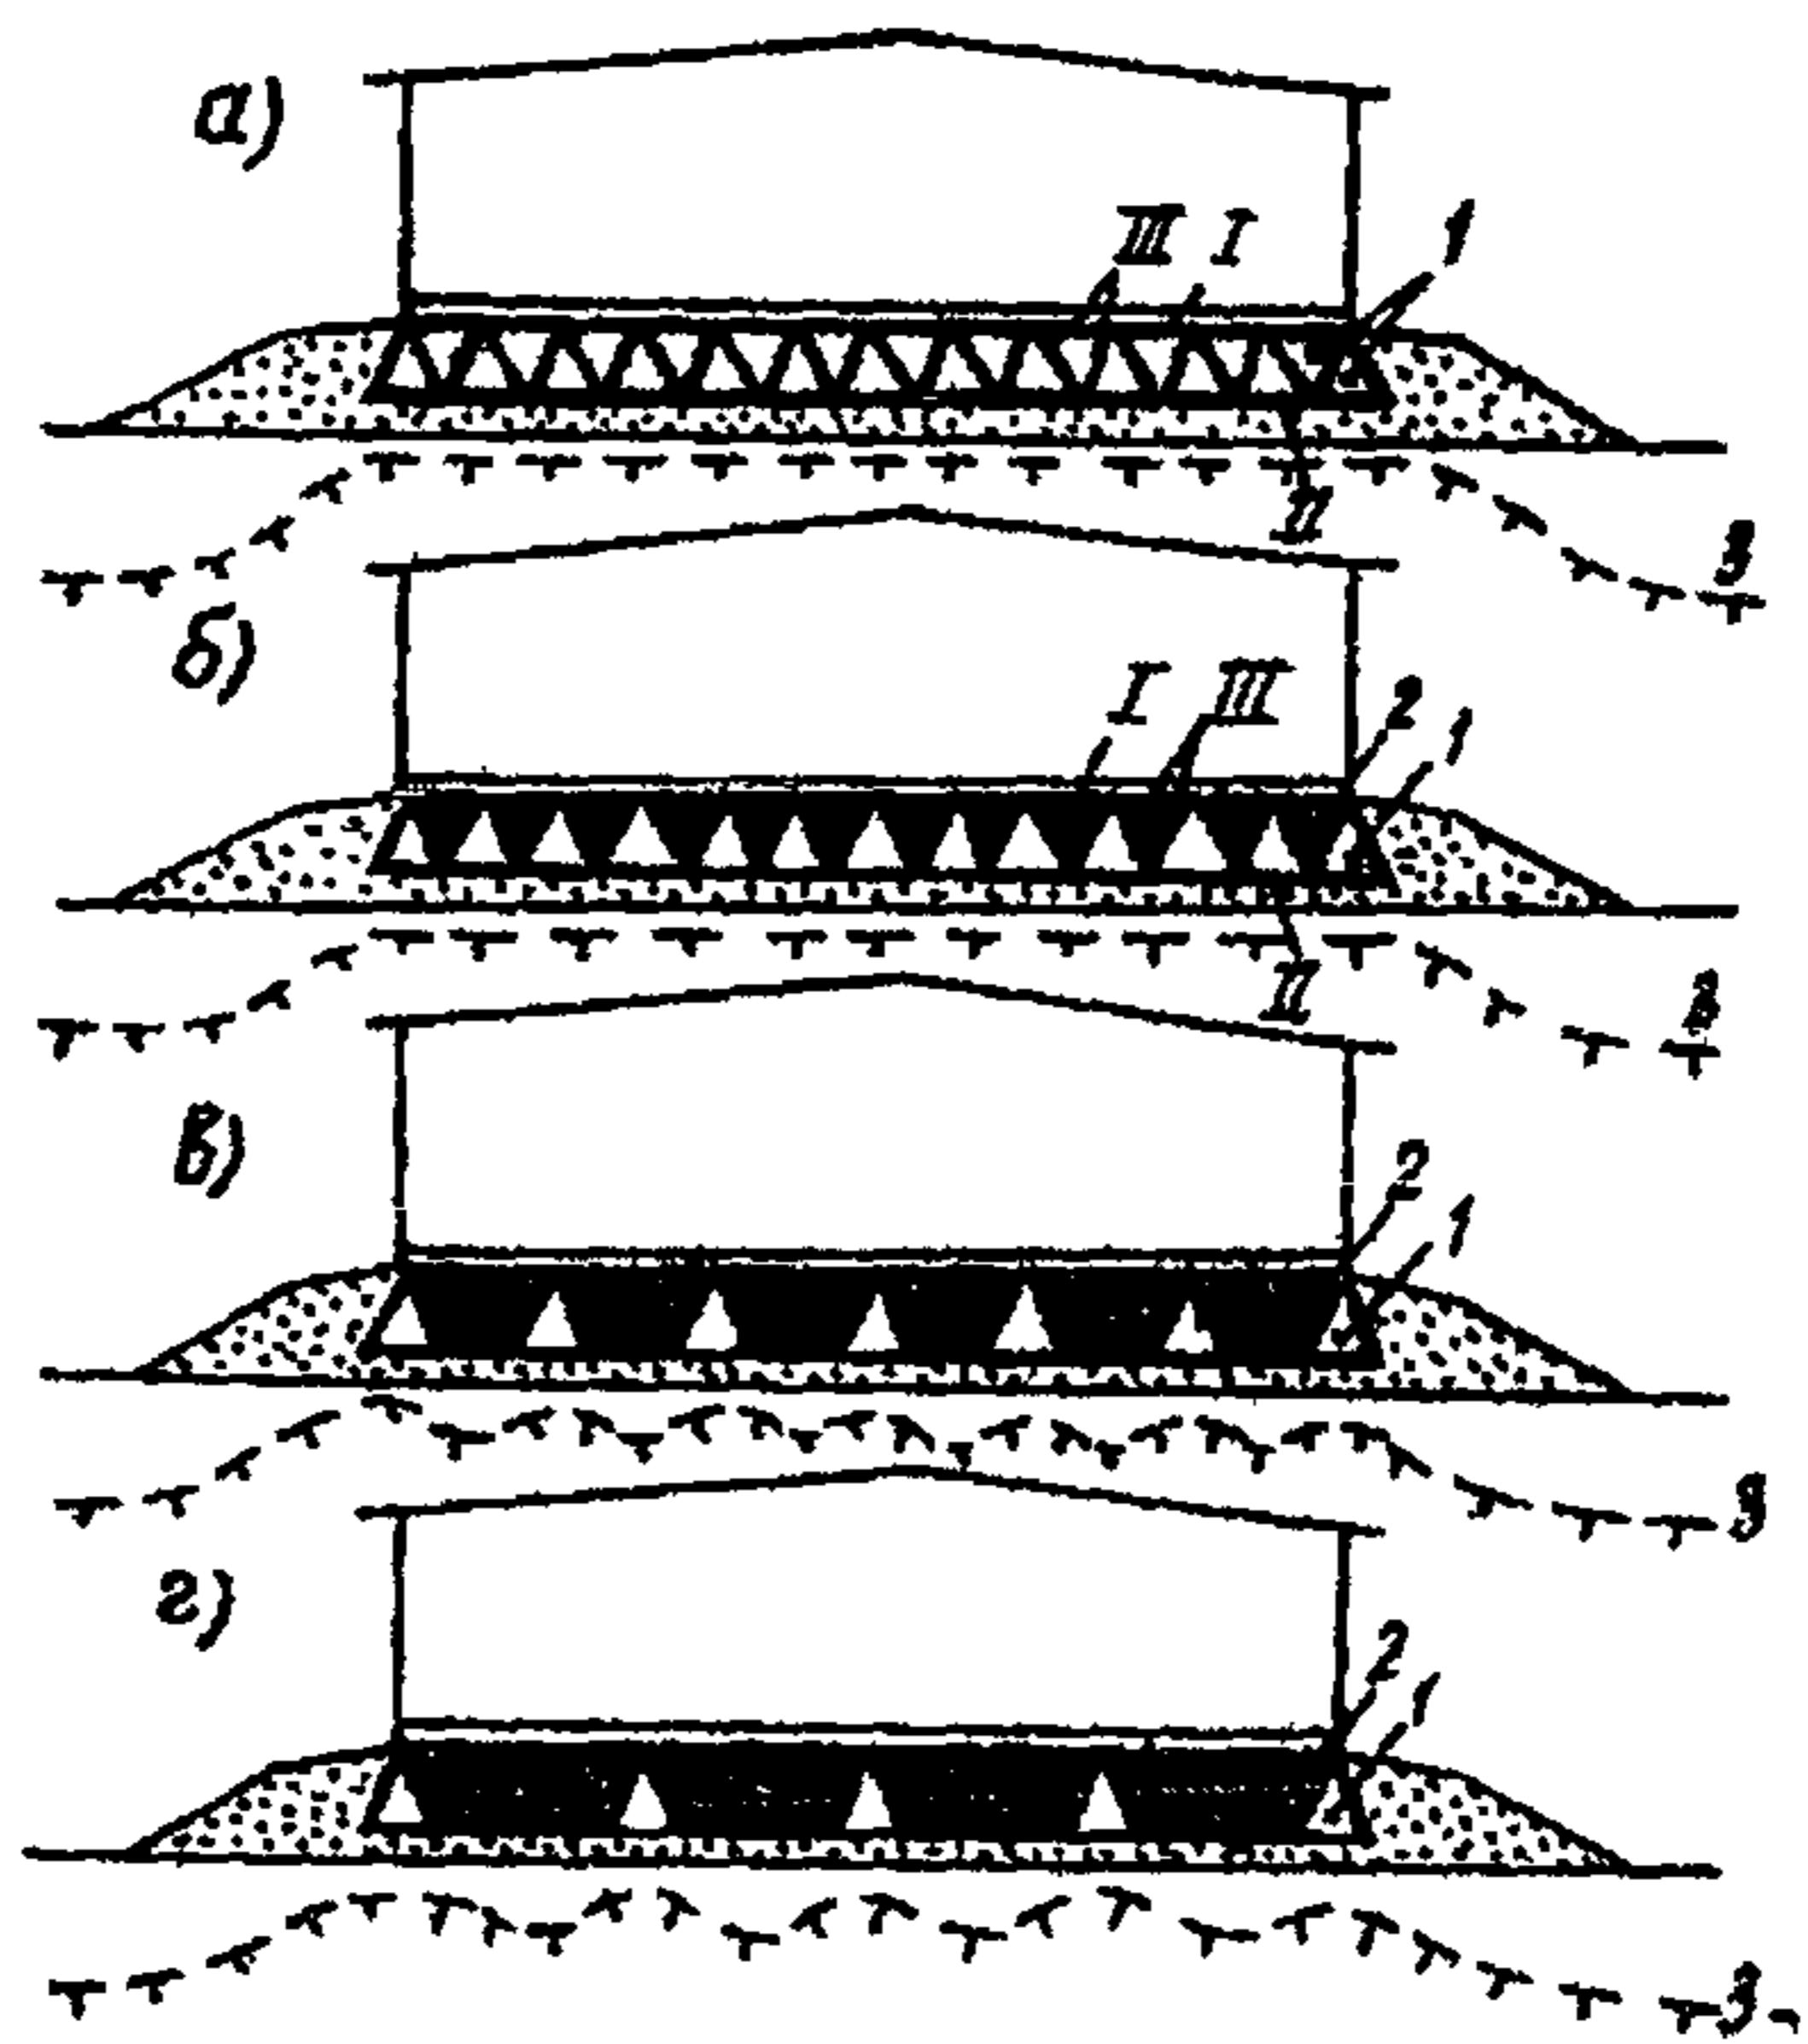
Рис. I. Схемы охлаждения грунтов оснований плитных фундаментов:
